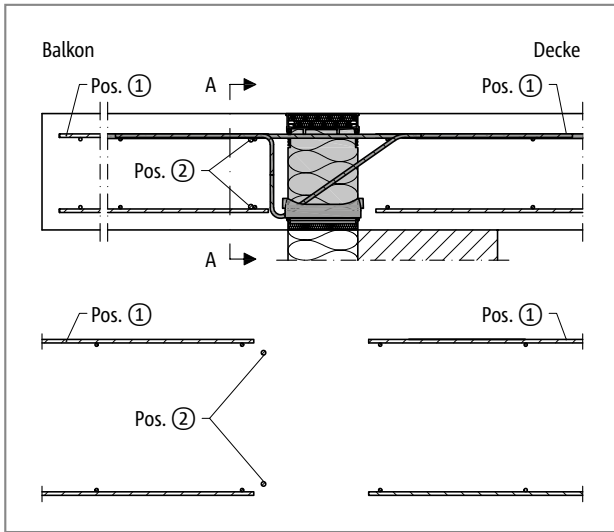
Schöck Isokorb® XT Typ K: Bauseitige Bewehrung bei direkter Lagerung
